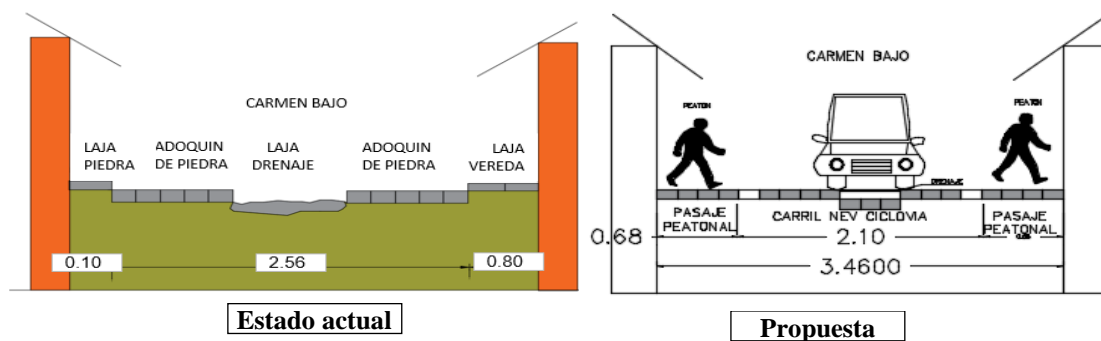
Propuesta de la sección transversal para la calle Carmen Bajo
